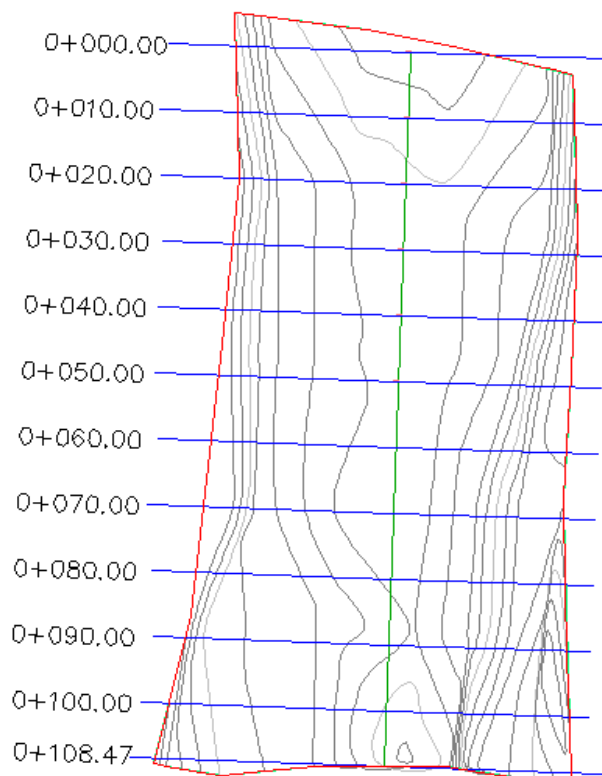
Vista en planta, tramo rio zulía (Fuente: Autocad)
